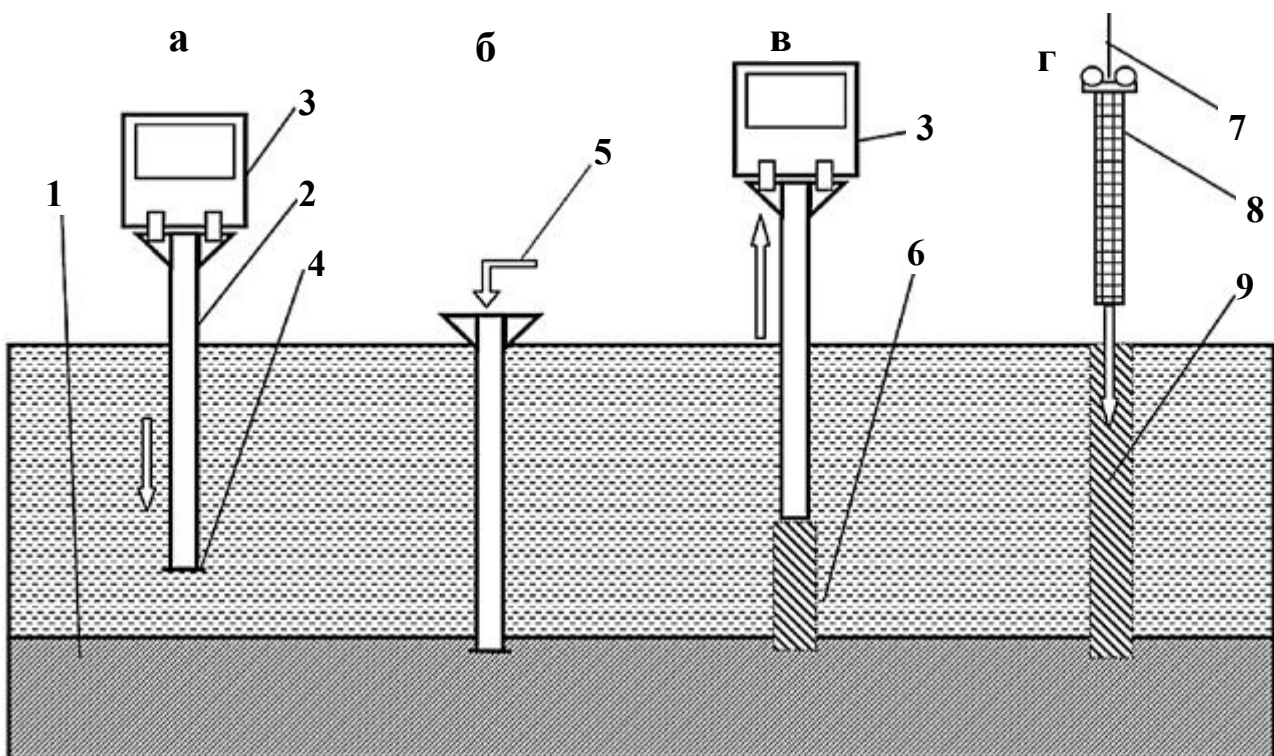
Етапи влаштування вібранабивної палі: 1 – щільний ґрунт; 2 – обсадна труба; 3 – віброзанурювач; 4 – башмак, що втрачається; 5 – подавання бетону цебром або бетононасосом; 6 – стовбур свердловини, заповнений бетоном; 7 – вібратор на крані для занурення арматурного каркаса; 8 – арматурний каркас; 9 – палі в ґрунті
